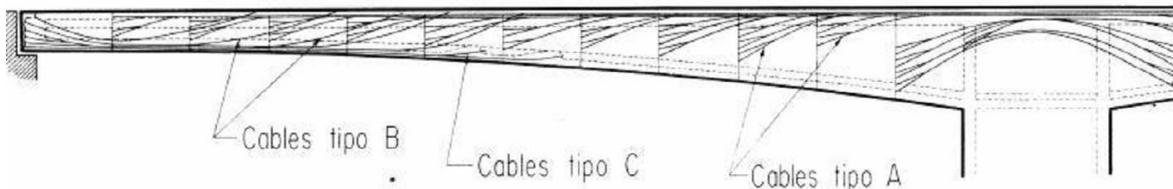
Distribución típica de los cables de presfuerzo en un voladizo.
